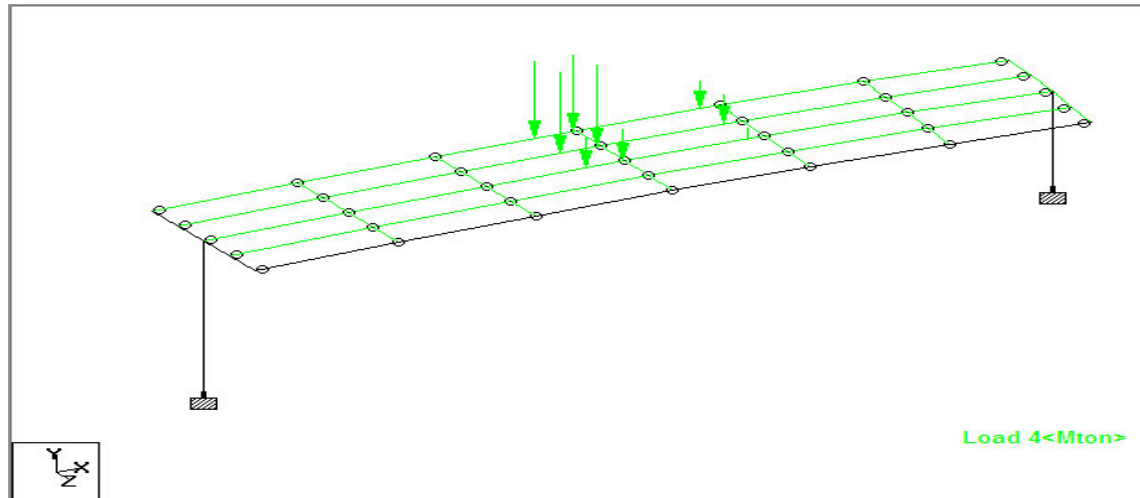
Modelo del entramado plano con el tren de cargas vivas del ensaye.
